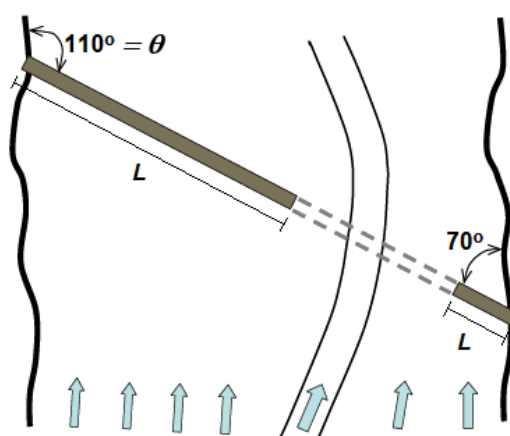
Calcolo dello scalzamento in corrispondenza delle spalle: definizione dei parametri.
